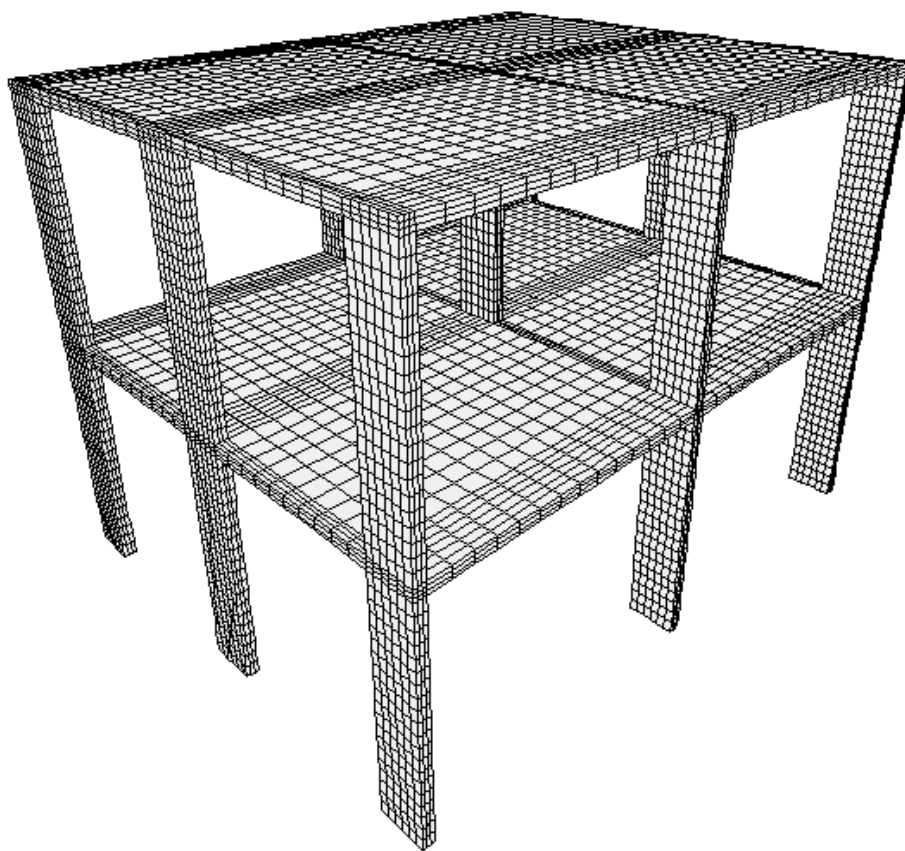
Estrutura em lajes lisas com dois pavimentos
